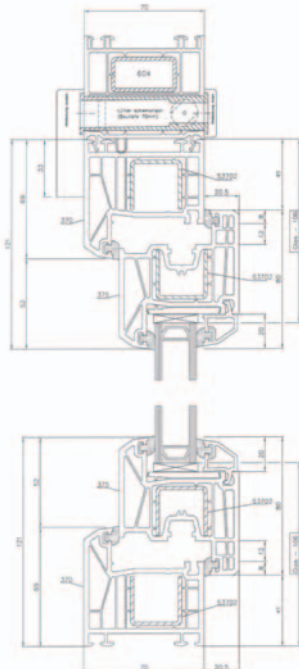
Einbaulage AirTronic im Fenster (Variante 70 mm)
